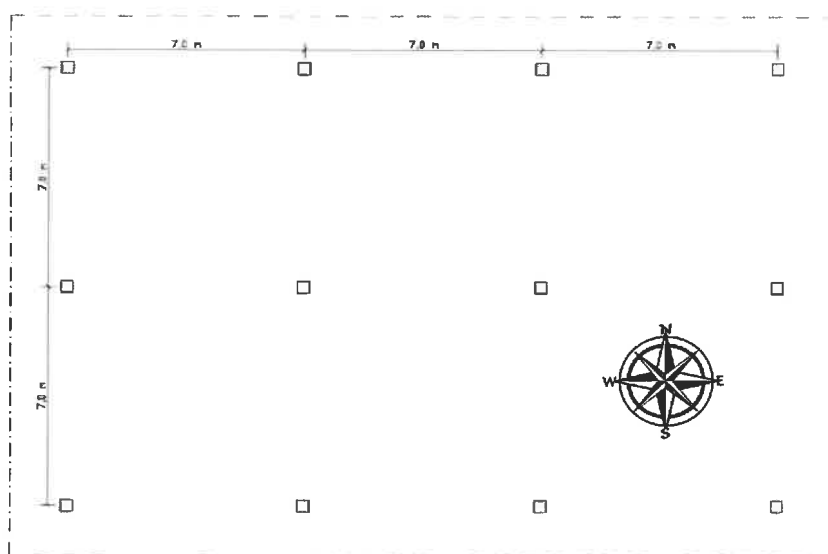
Replanteo de la planta de cubierta disponible para la instalación fotovoltaica
